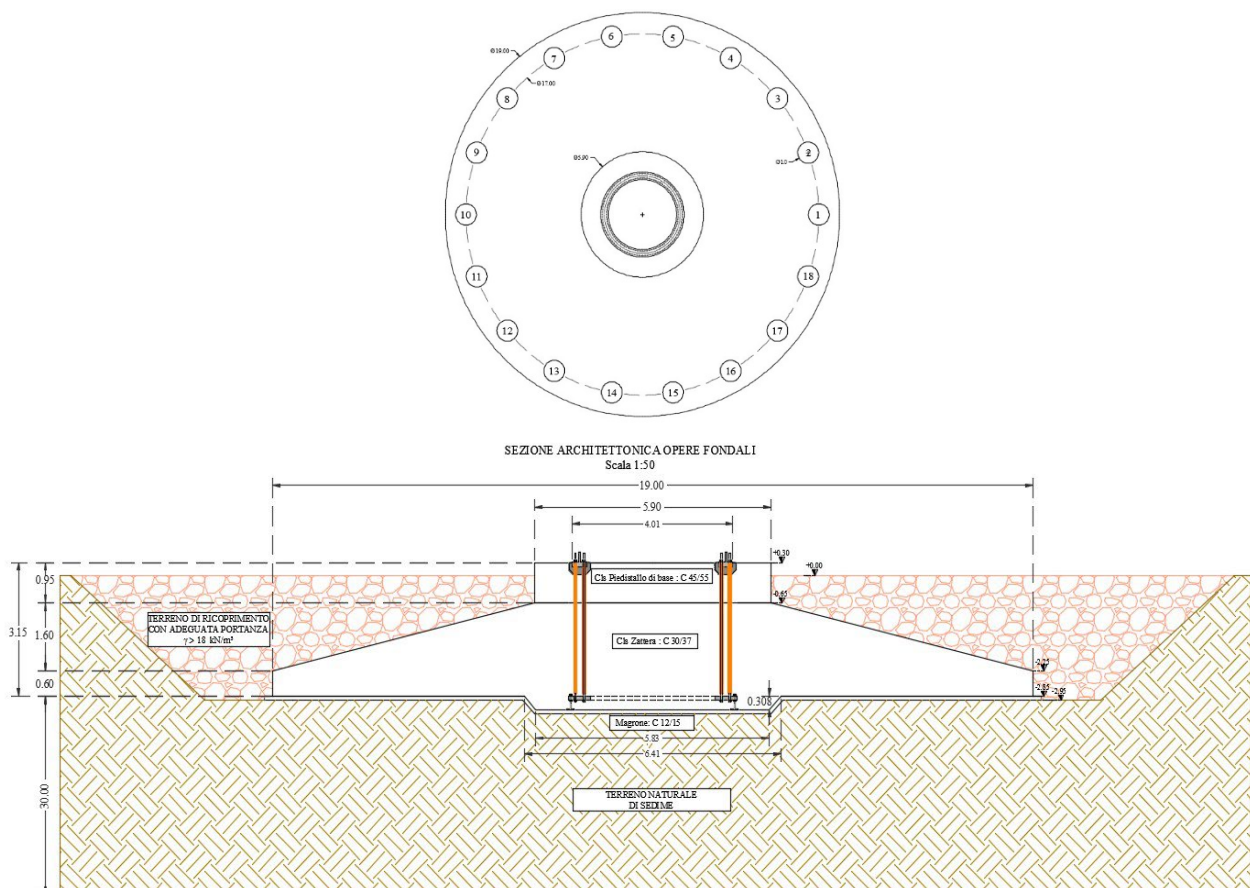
Pianta architettonica e sezione delle fondazioni dell'aerogeneratore con caratteristiche geometriche
